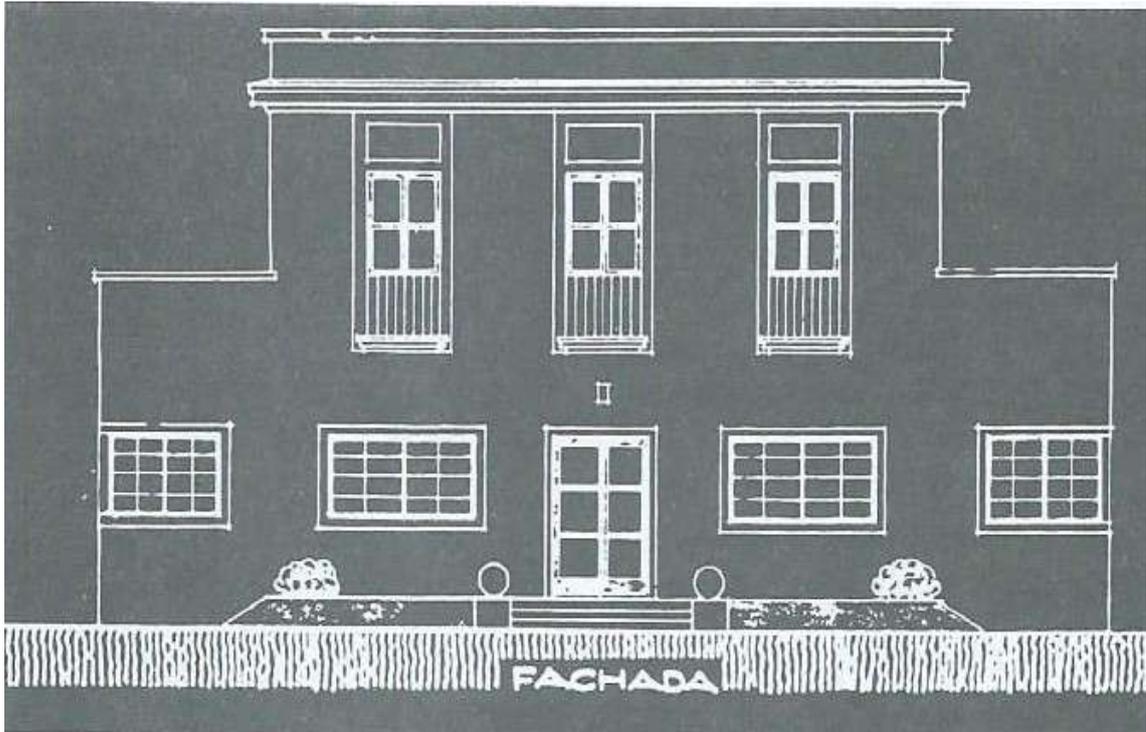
Projeto da fachada casa da rua santa cruz do arquiteto Warchavchik apresentado ao serviço de censura de fachada, em São Paulo, para obtenção de licença de construção
